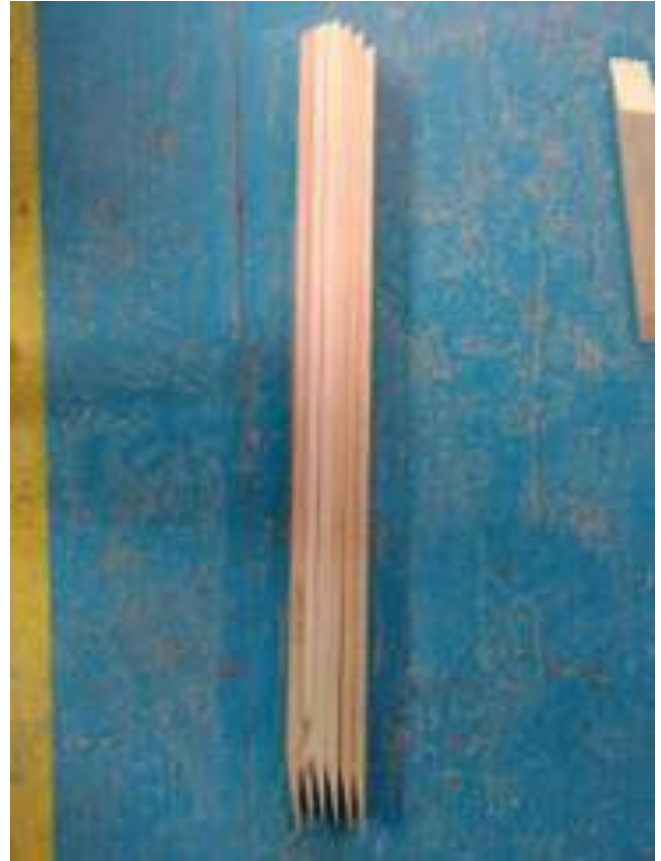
Madera de ayacahuite para los marcos estructurales de la cubierta
